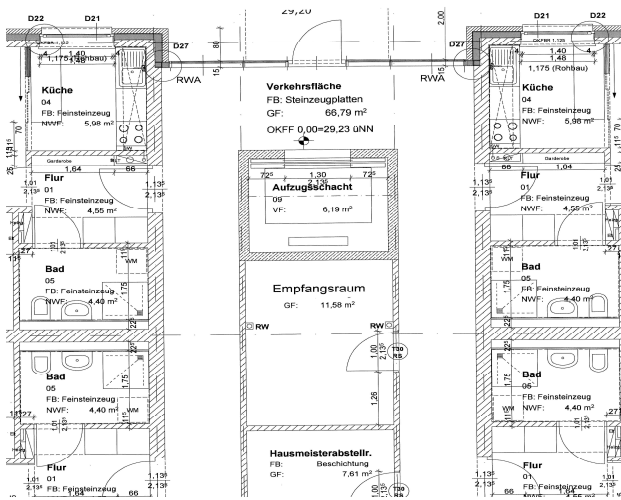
Grundrissausschnitt vom Erdgeschoss. Lage vom Aufzugsschacht zum Empfangsraum.
